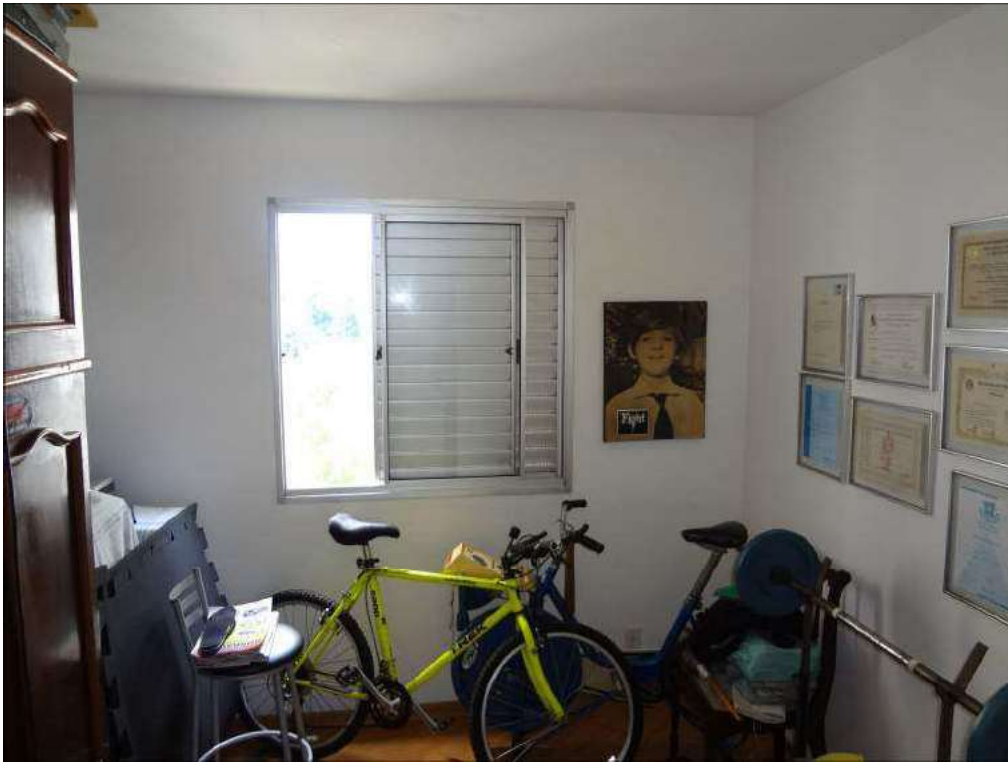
Dormitório 2, destaque para a laje de forro e a esquadria em alumínio.
